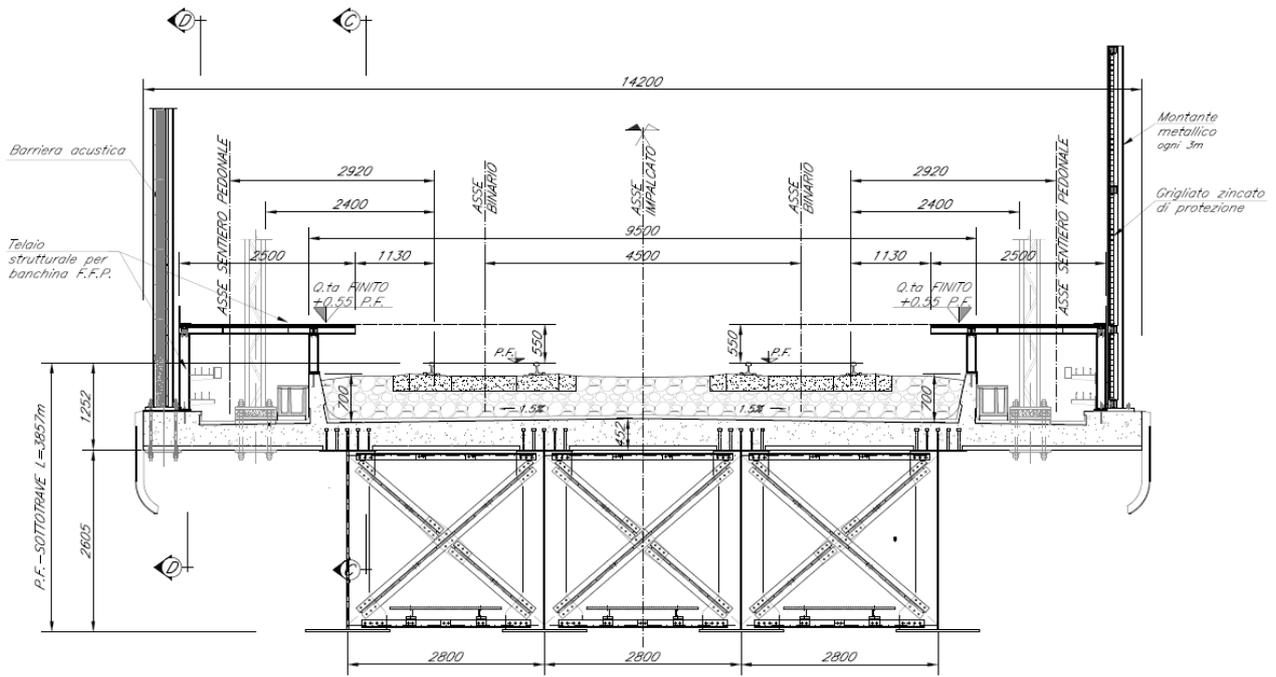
Sezione trasversale tipo con Fire Fighting Point
